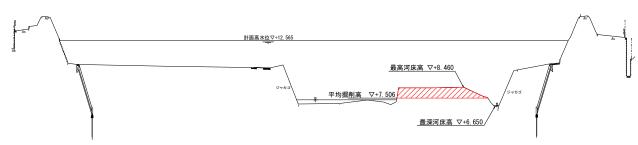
B-B断面図 (猪名川 6.4k 付近)
